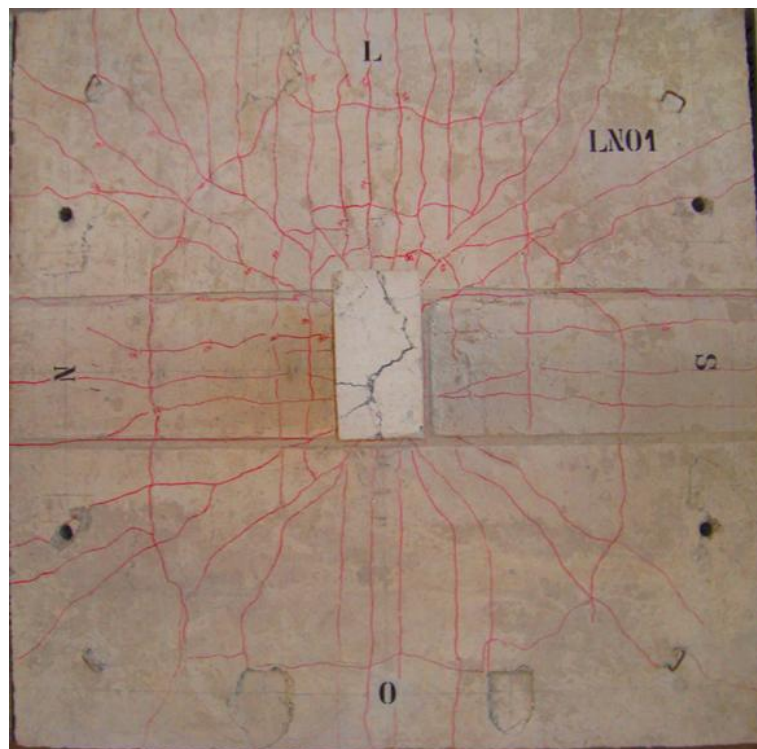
Padrão de fissuração do modelo LN01.
